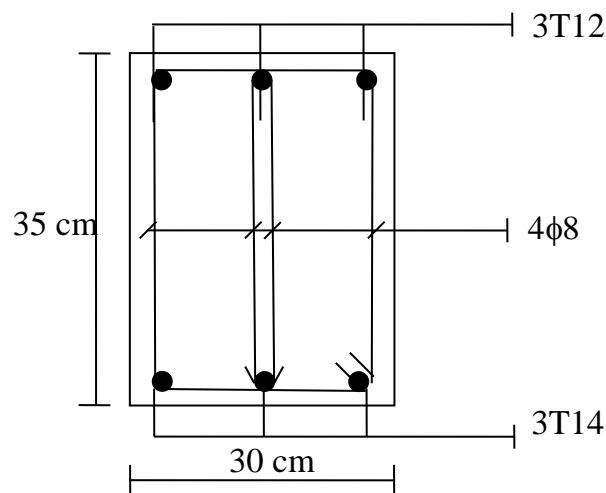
Schéma de ferrailage de la poutre secondaire (en travée)
